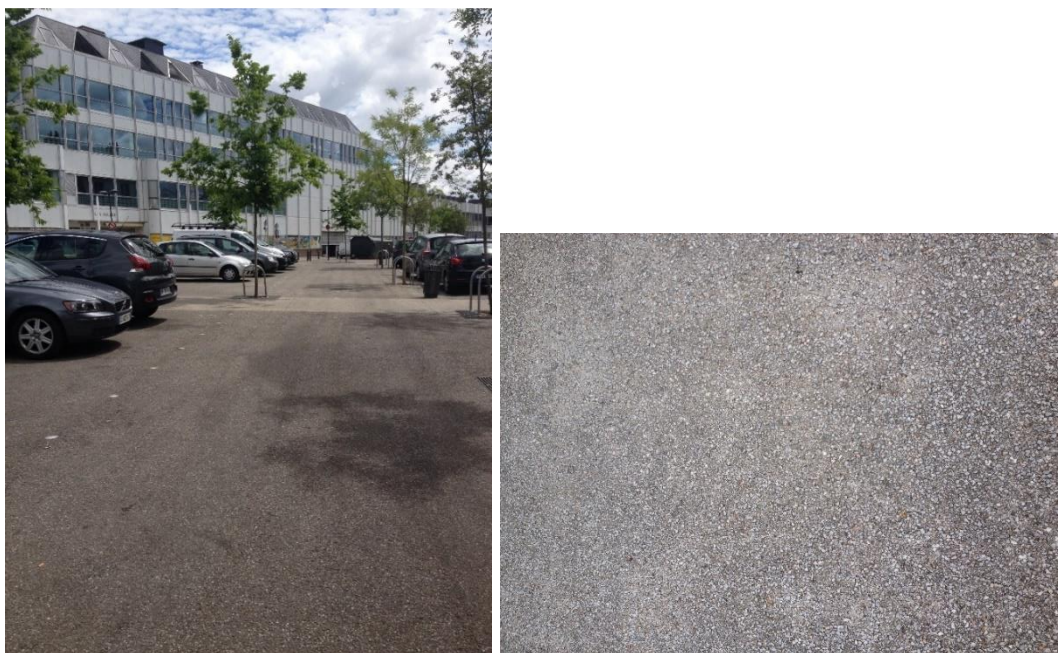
exemple de revêtement au sol et clous (parking des Halles de tours)
